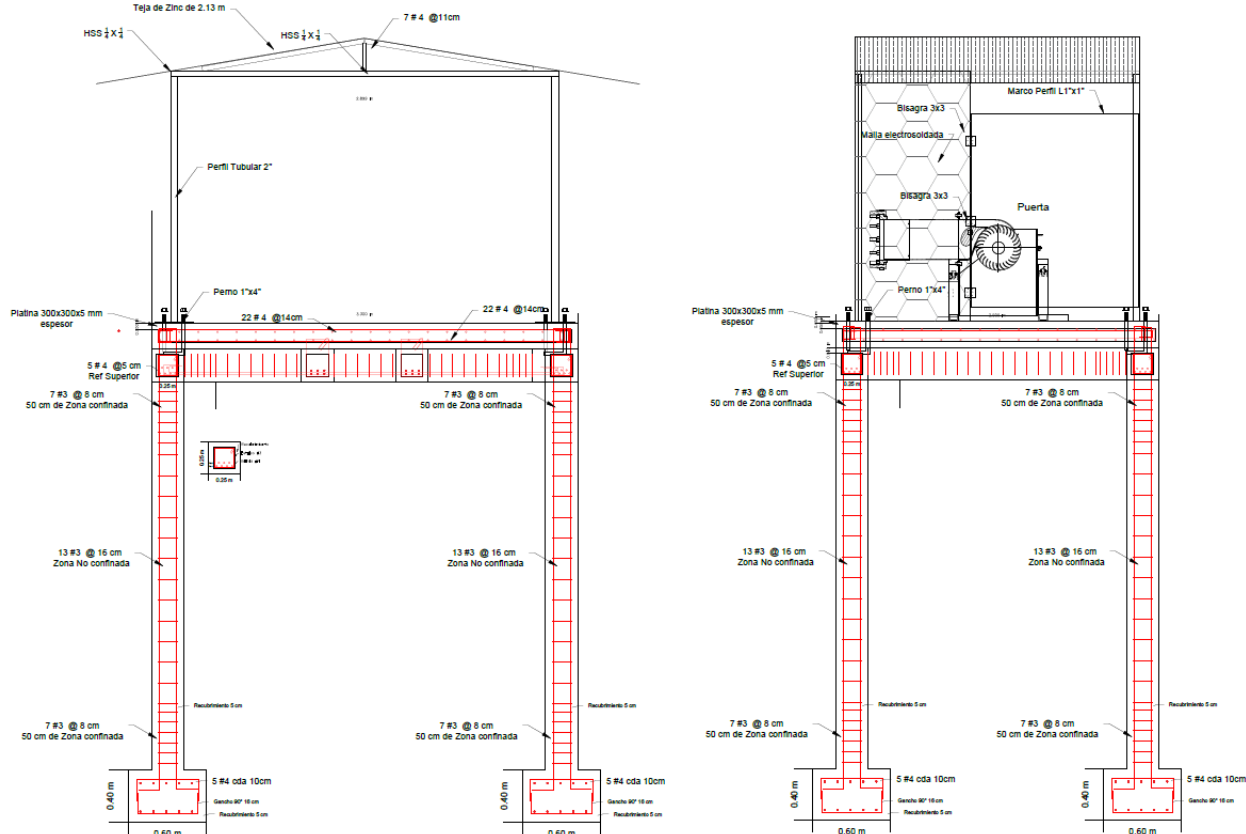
Diseño de detalle de estructura elevada tipo caseta para instalación y anclaje de la turbina: Segundo detalle.
